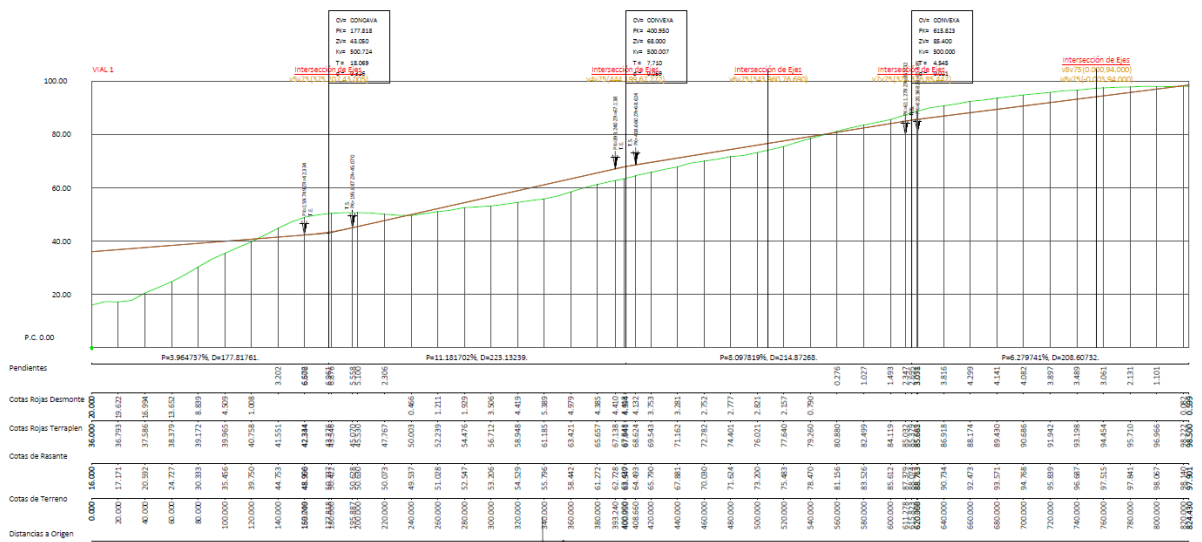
Imagen de la sección longitudinal del vial 1 en la alternativa 1.
